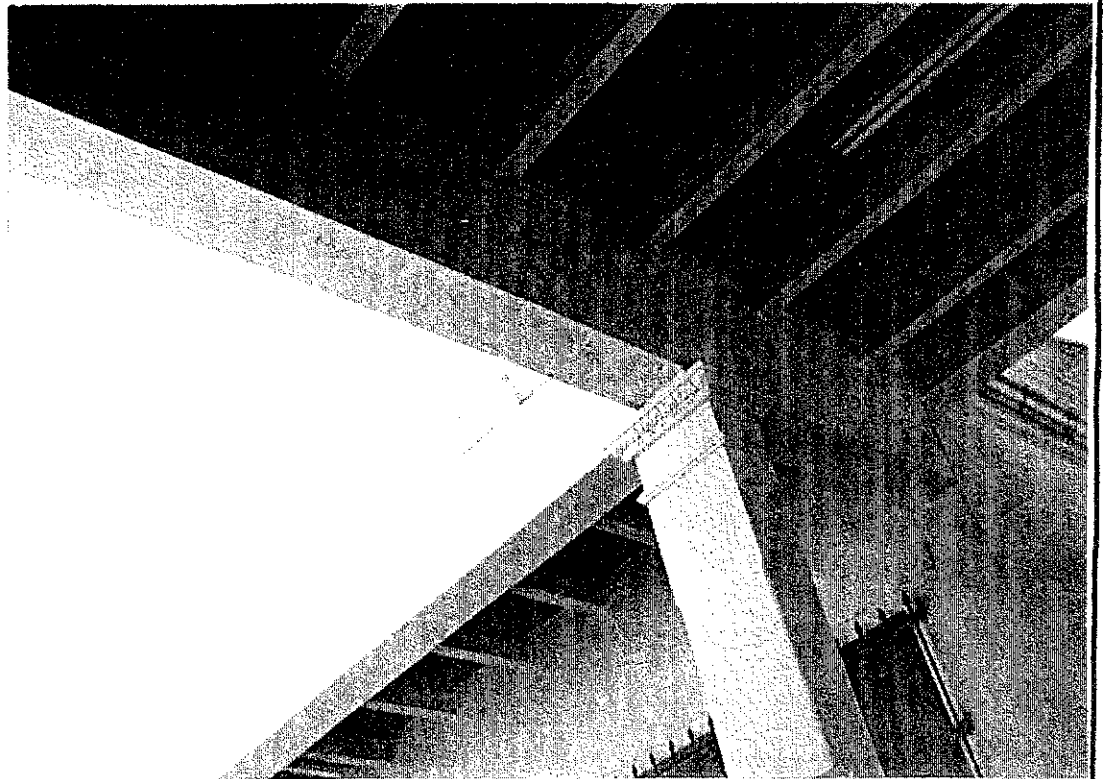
Humedades y fisuras en vigas de cubierta de corredores
